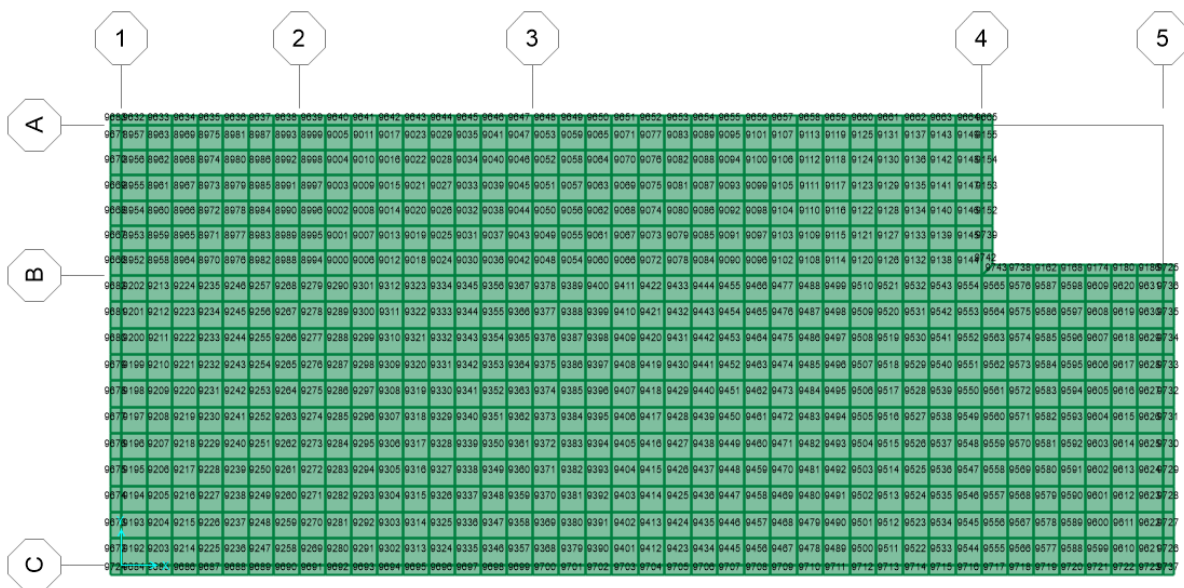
Pianta del modello di analisi della platea di fondazione – numerazione elementi shell e frame
